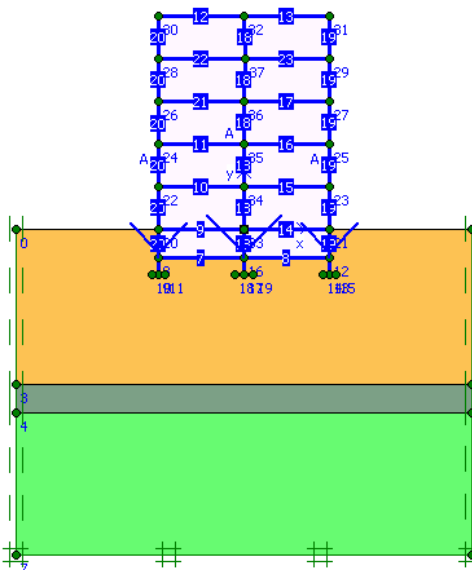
Схема № 5. Задана надземная часть здания с перекрытиями. Нагрузка передается как сосредоточенная на обреш фундамента
